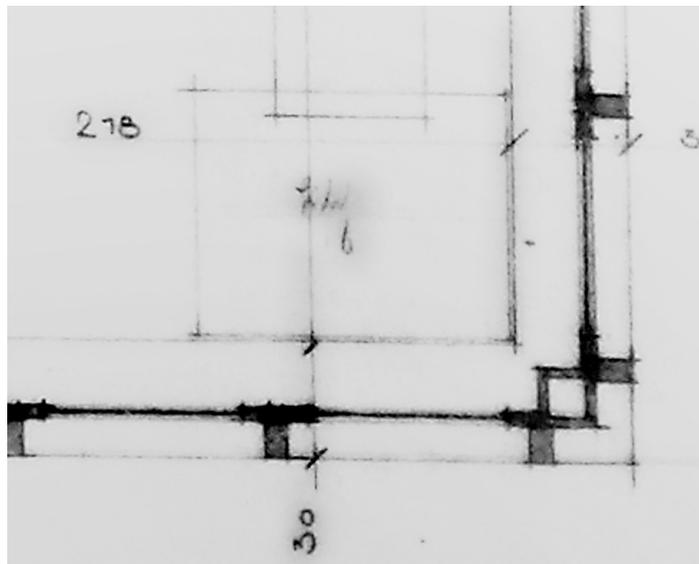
Haus Müller-Drenkberg, Detail Eckfenster, ohne Datum
